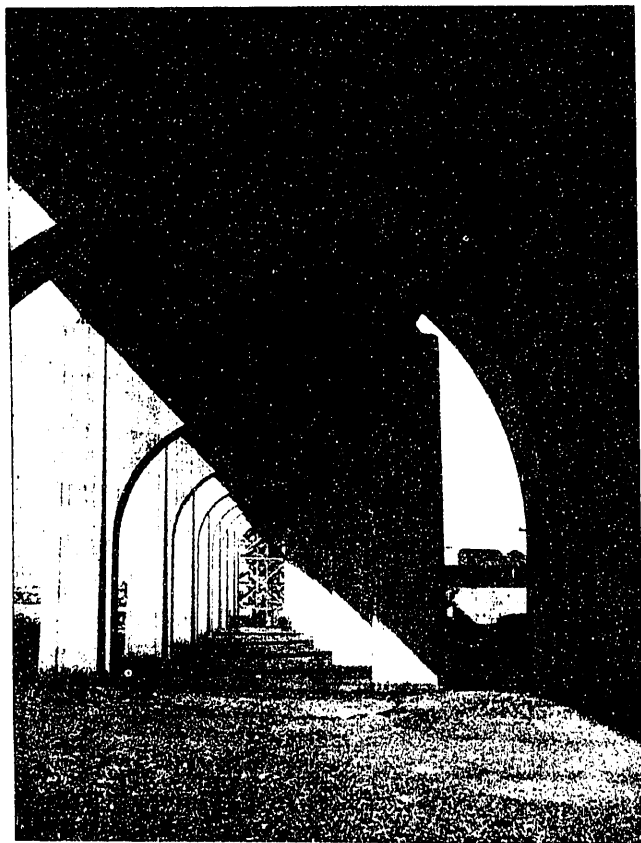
Puente de Kill-van-Kull.-Apoyos de los tramos de acceso
